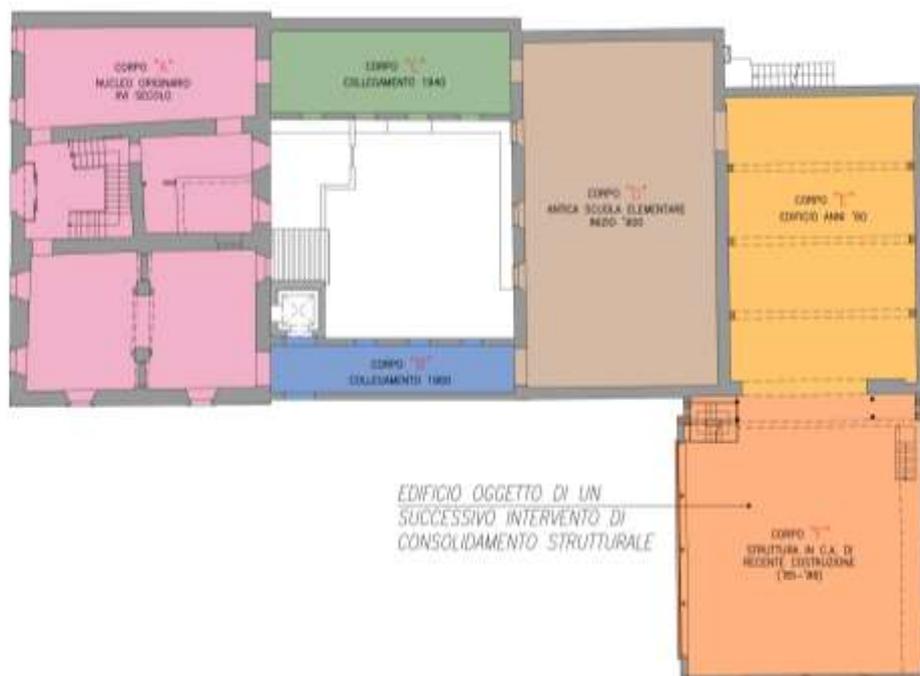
PLANIMETRIA DEGLI EDIFICI DEL COMPLESSO MUSEALE
